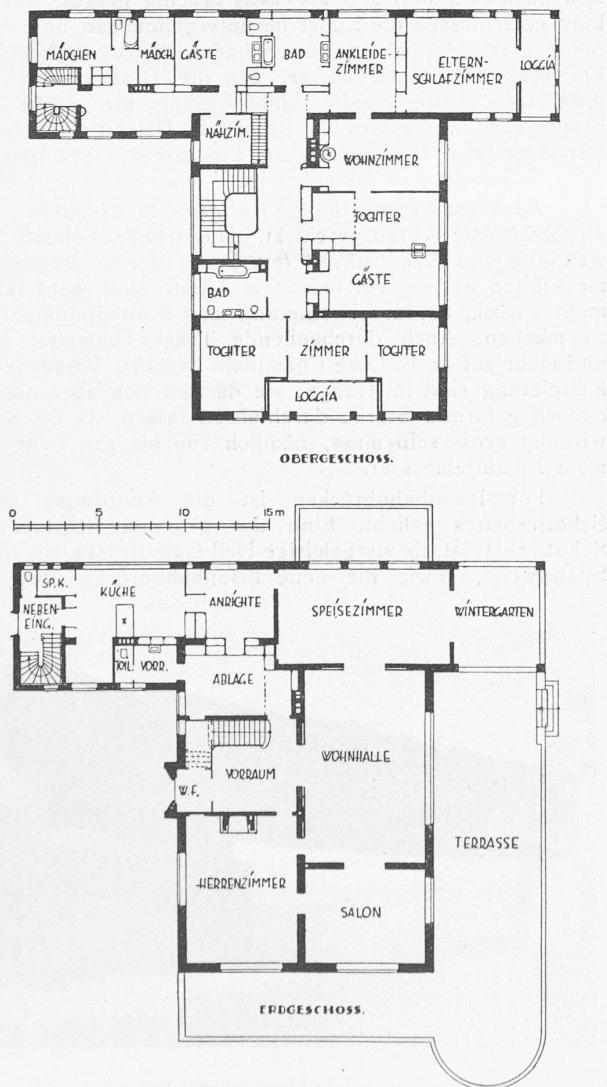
und 7. Grundrisse zum Hause Dr. B. in Dahlem. — 1 : 400.
